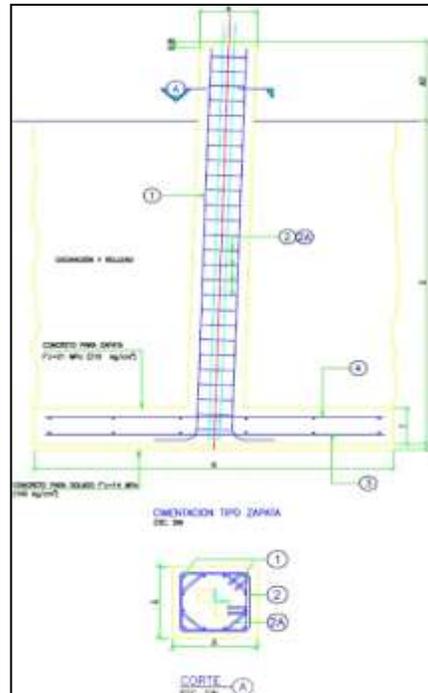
Esquema general típico para la cimentación tipo zapata
